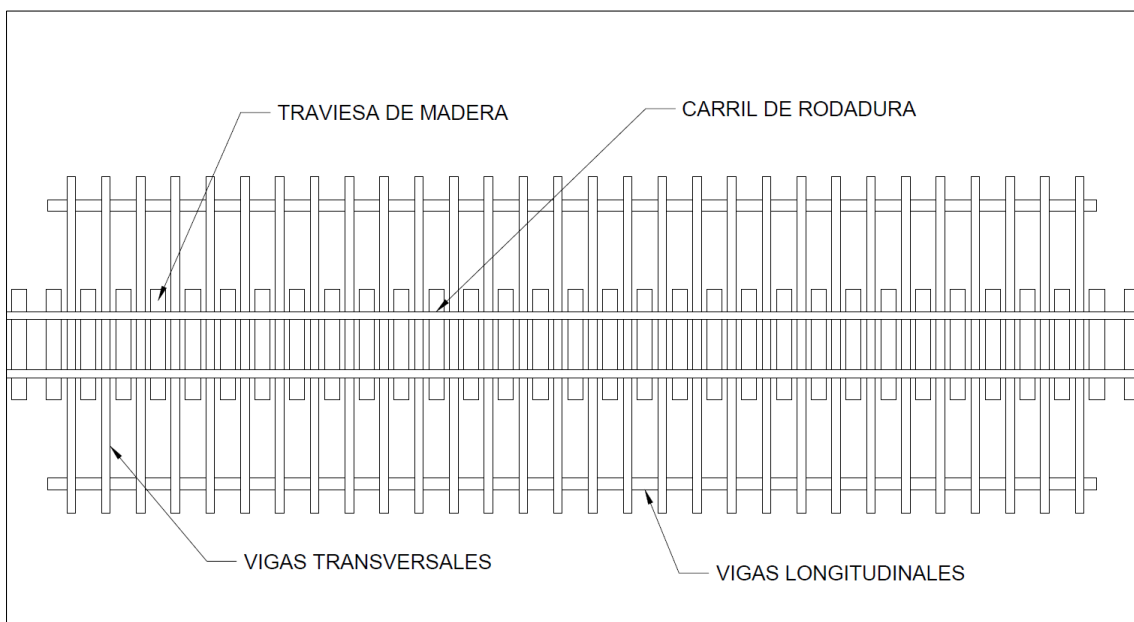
Croquis en planta del apeo de vía con los elementos básicos.
